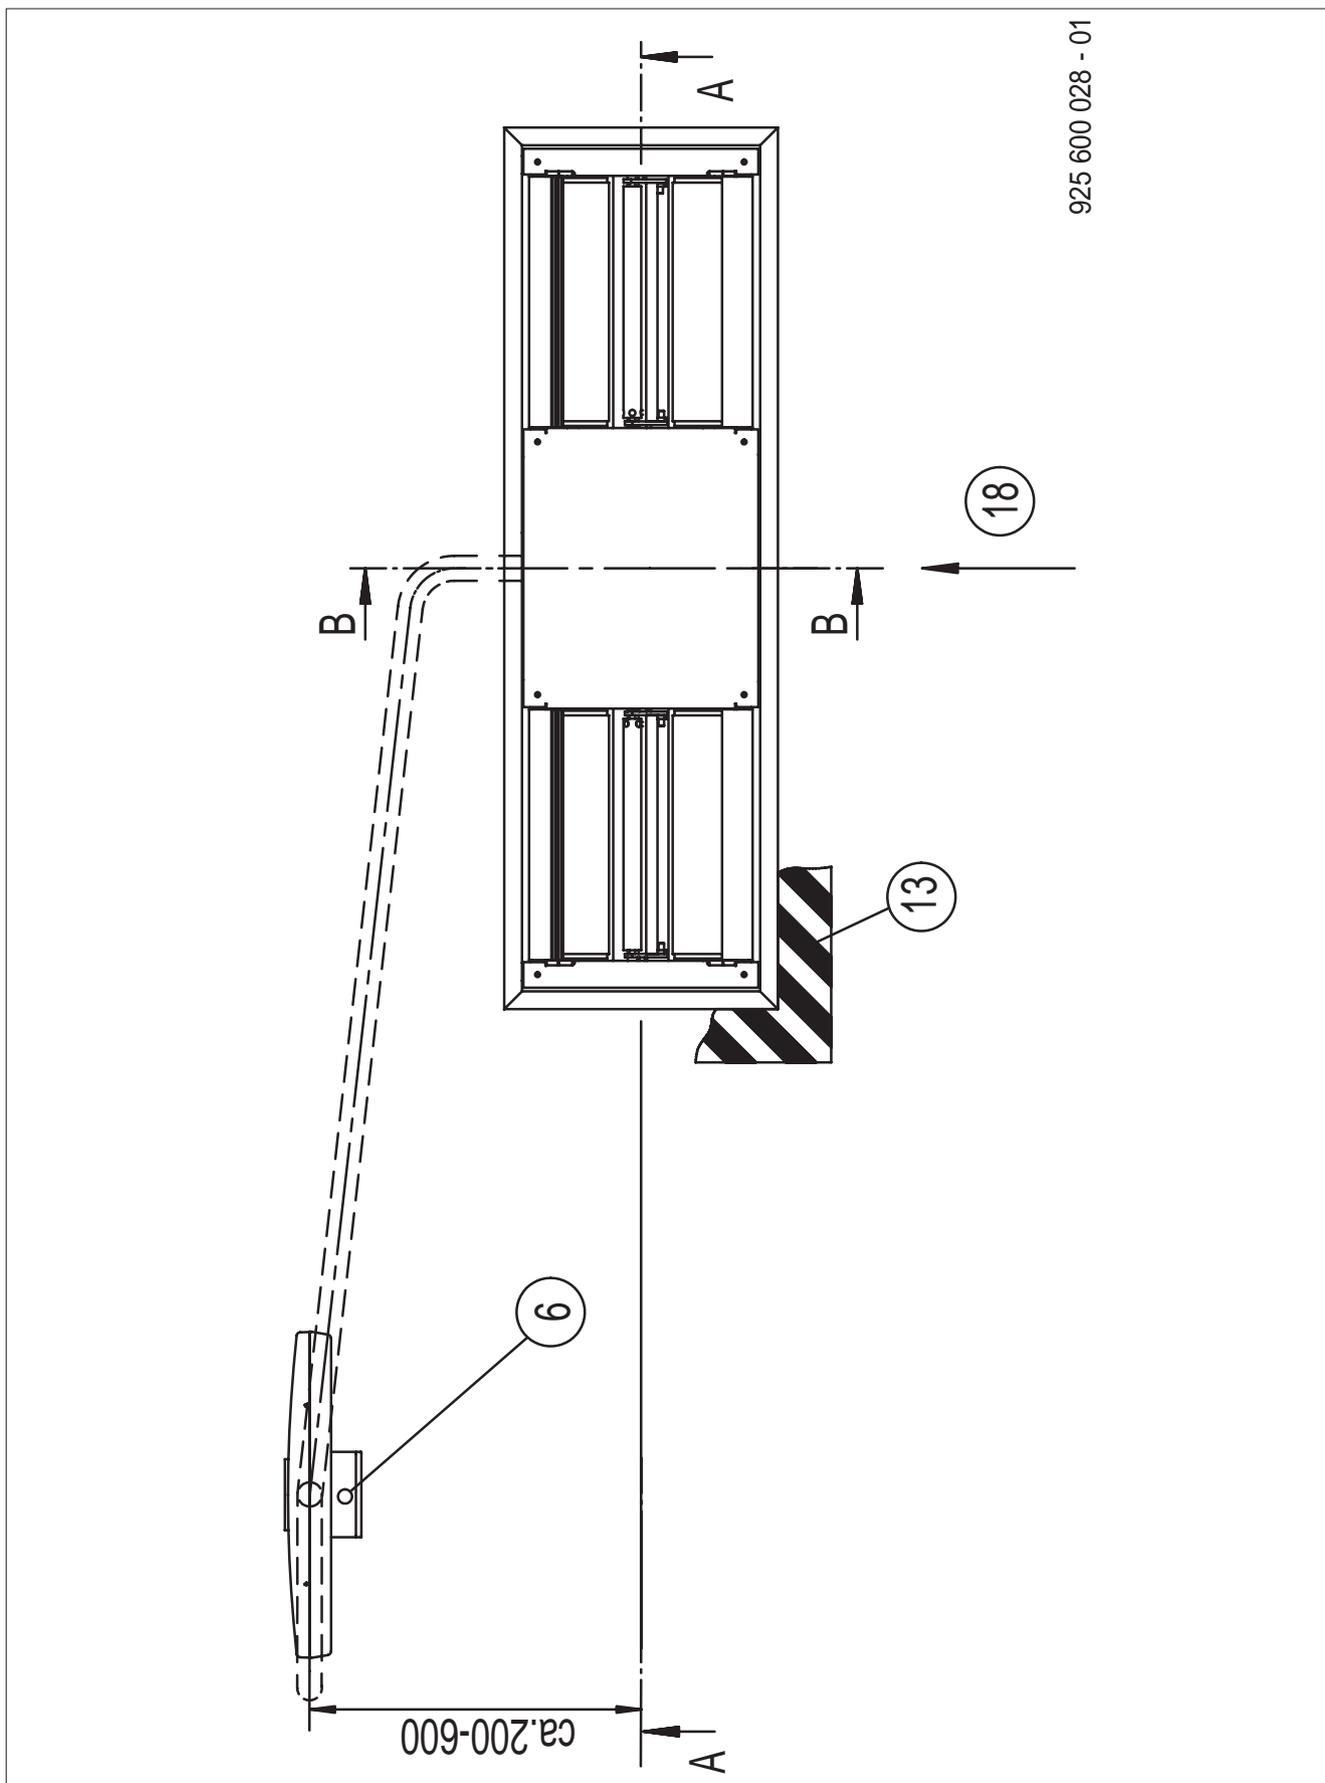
Installationsplan BD 6xx mit Standsäule - Grundriss
